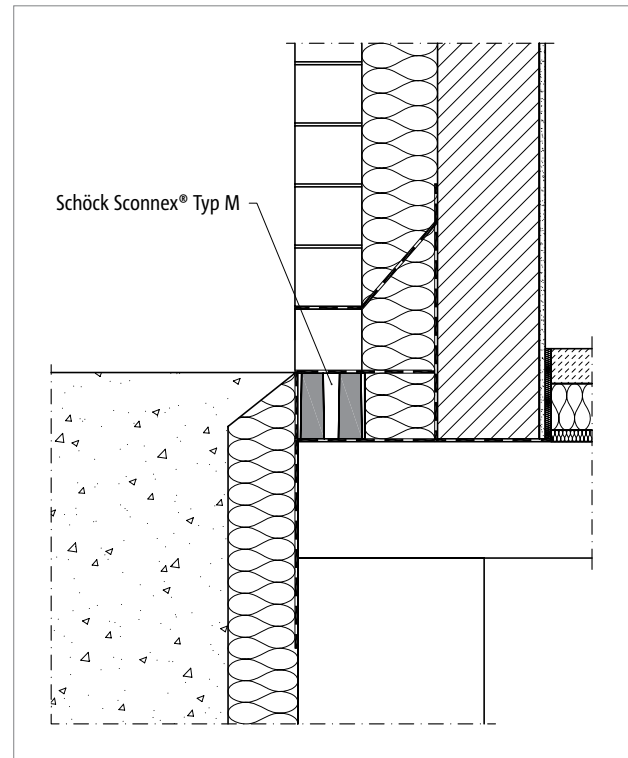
Schöck Sconnex® Typ M: Anschluss bei zweischaligem Mauerwerk
